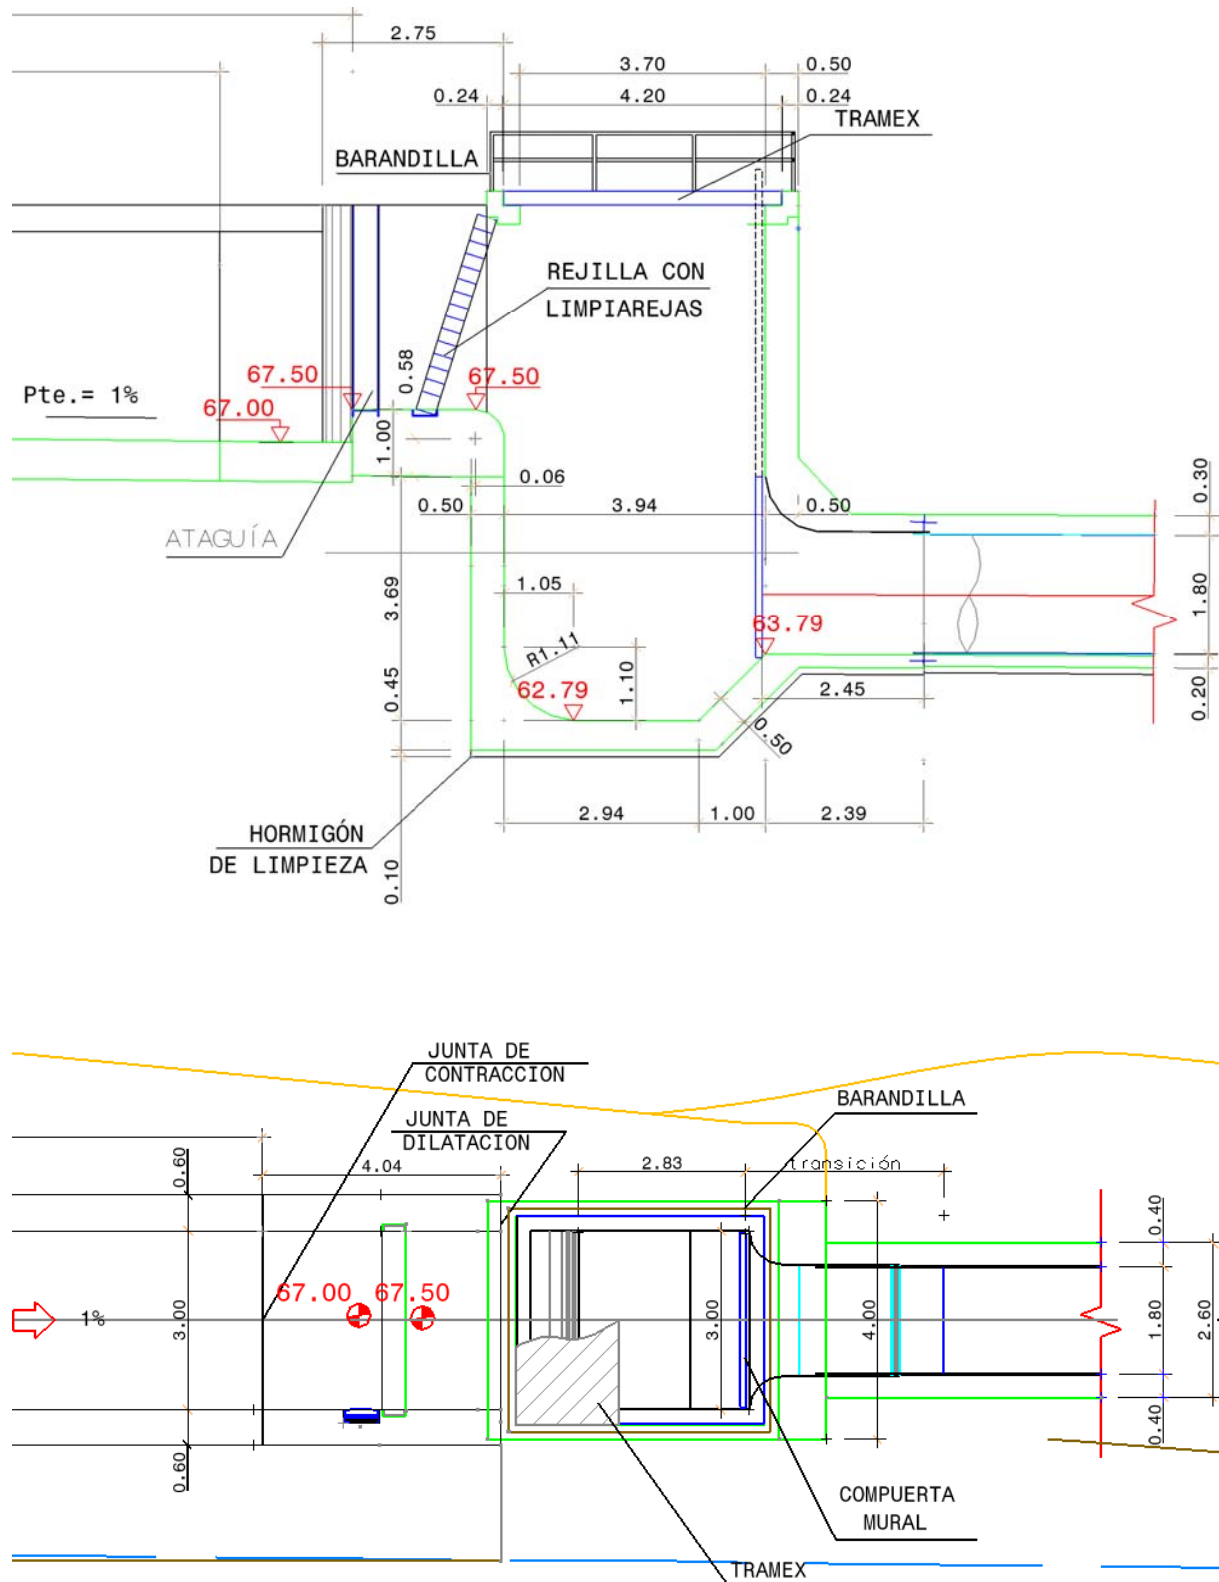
Plano de detalle de la ubicación de la compuerta mural.
